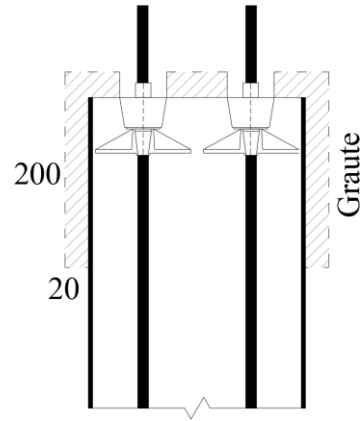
Armaduras dos pilares e blocos (Fonte: Autor)
